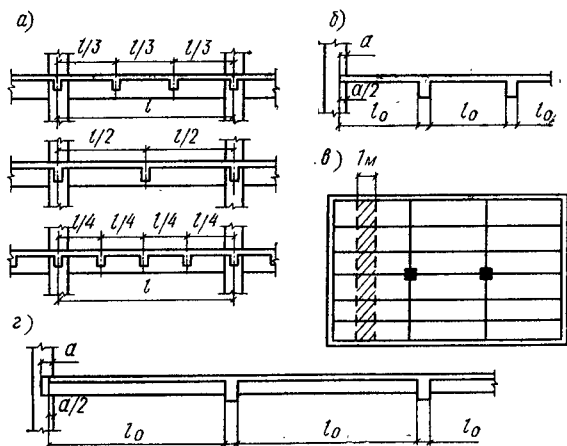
Схемы балок и плит ребристых перекрытий
